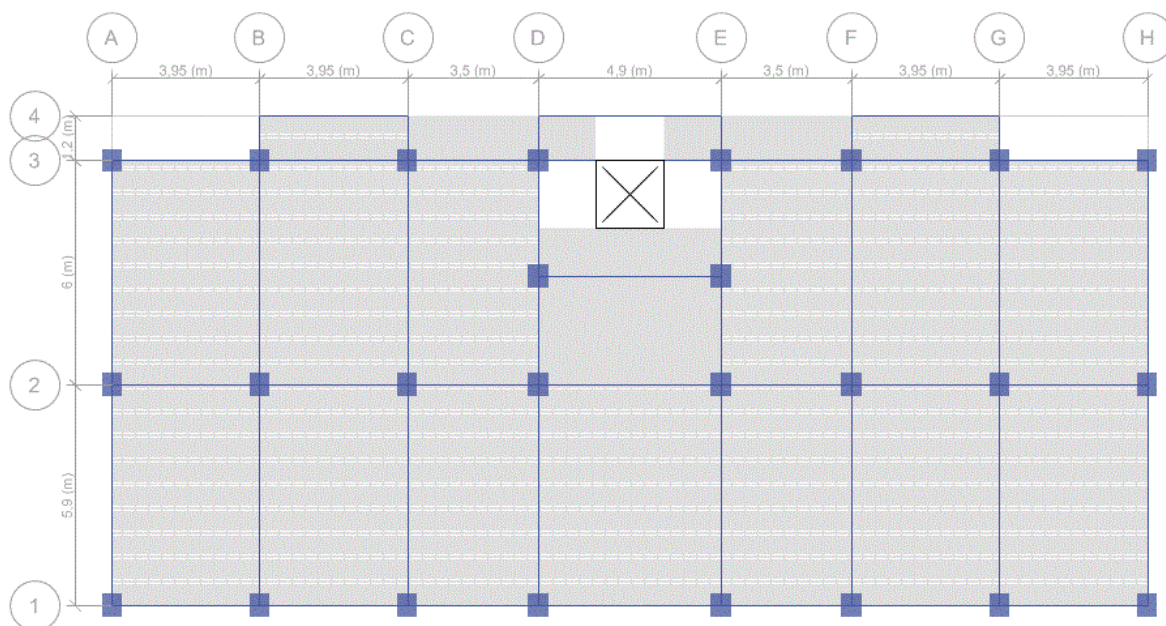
Vue en plan de la disposition des poutrelles (Etage 01 à 08).
